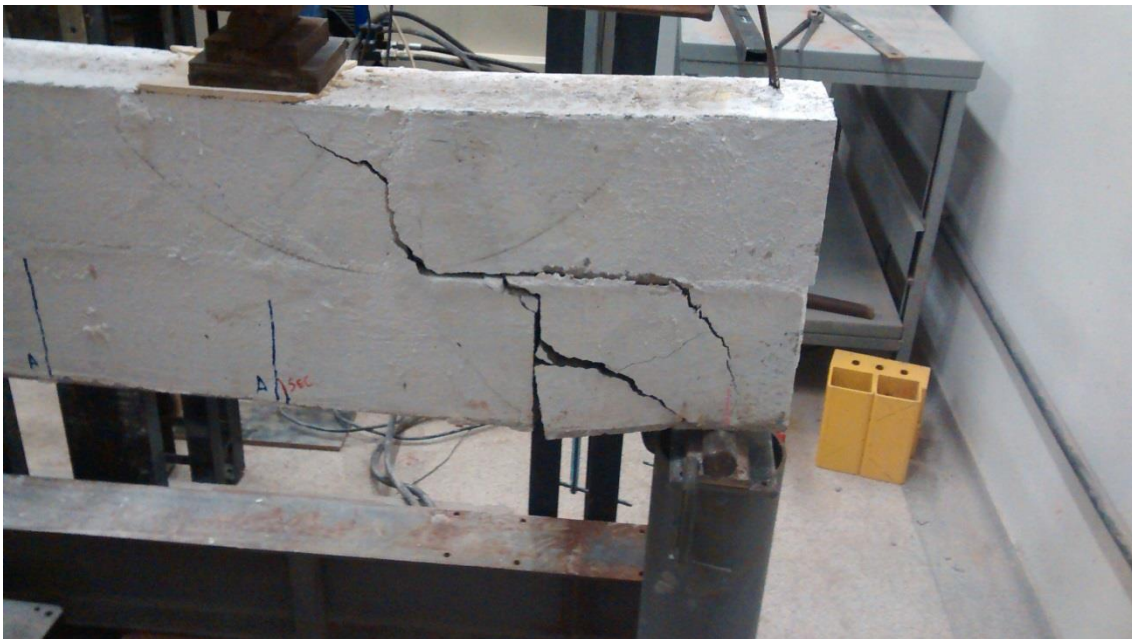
Fissuras Cisalhamento-Flexão
